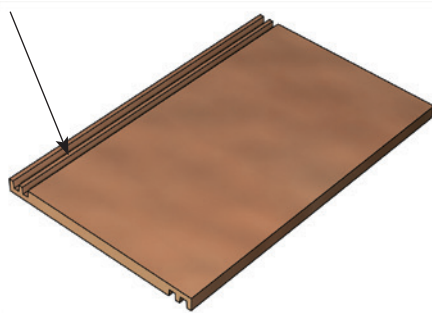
Tuile plane en béton à glissement et à emboîtement longitudinal
